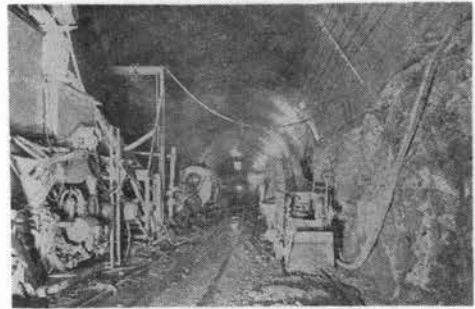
大阪方坑内土平返しと側壁コンクリート打設
